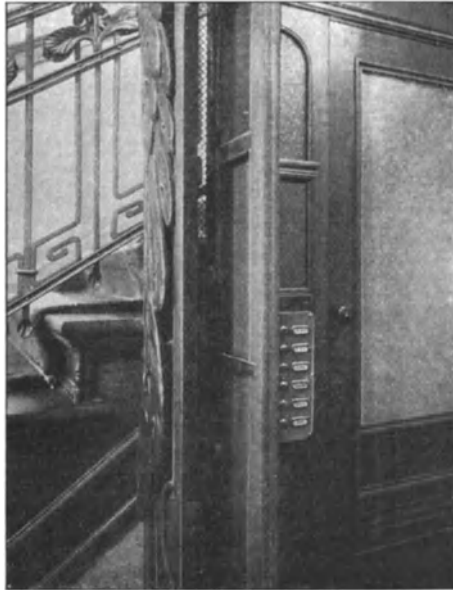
Blick in die Kabine eines Personenaufzugs mit Druckknopfsteuerung für ein Wohnhaus.
